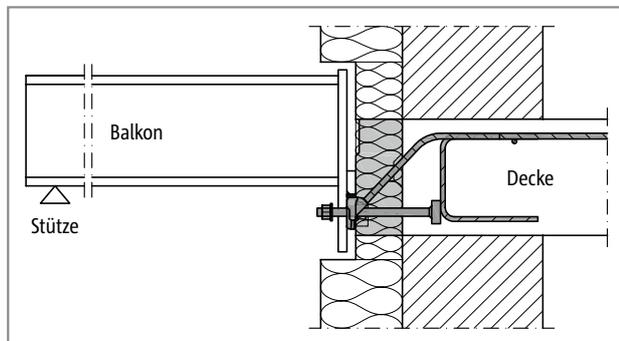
Schöck Isokorb® T Typ SQ: Barrierefreier Übergang durch Höhenversatz
